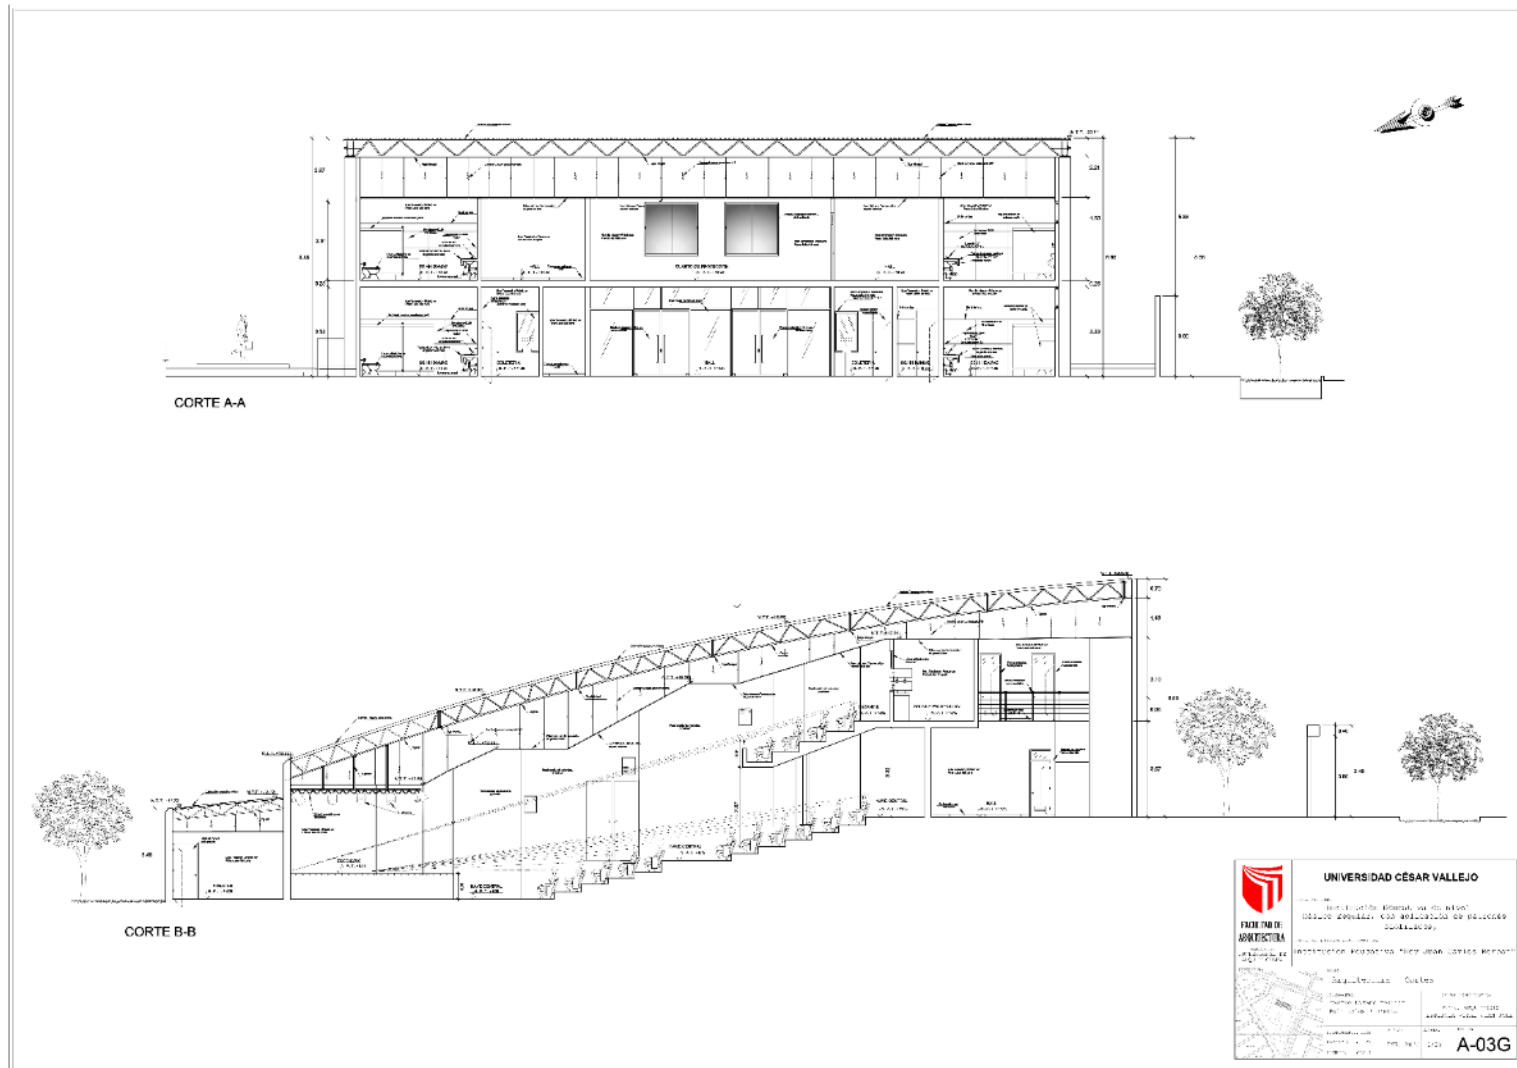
Plano de cortes bloque "G", Fuente: elaboración propia
